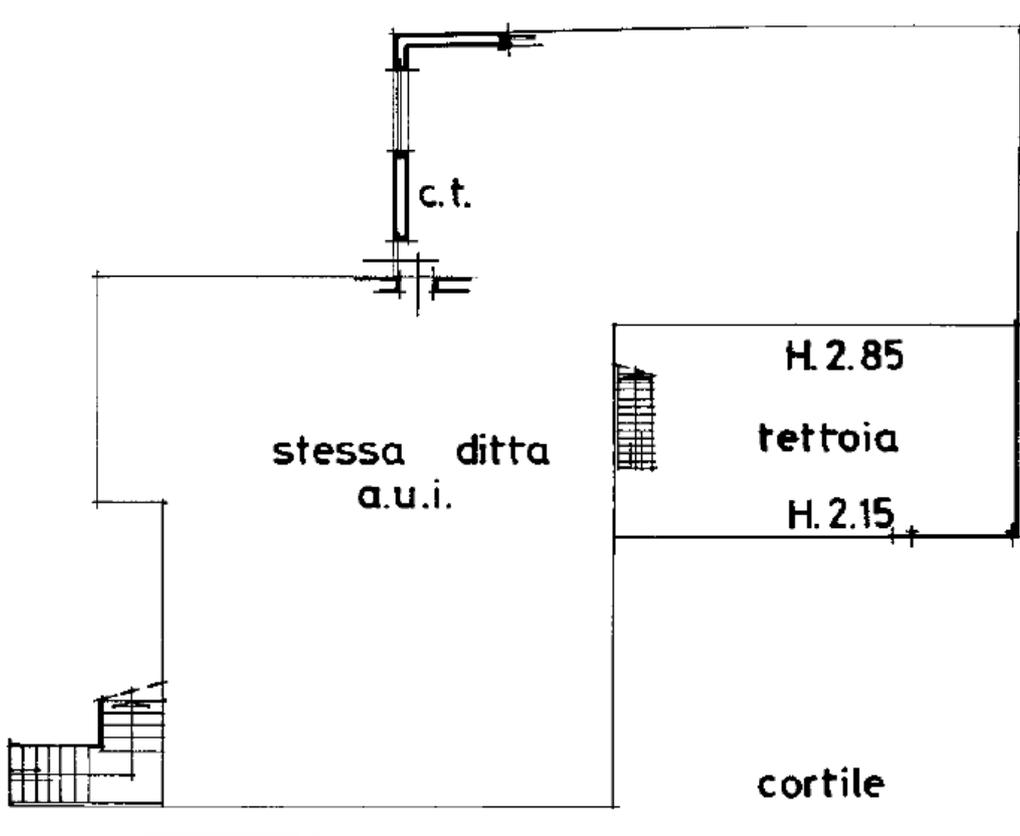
Estratto della planimetria catastale – sub. 4, p.t.
